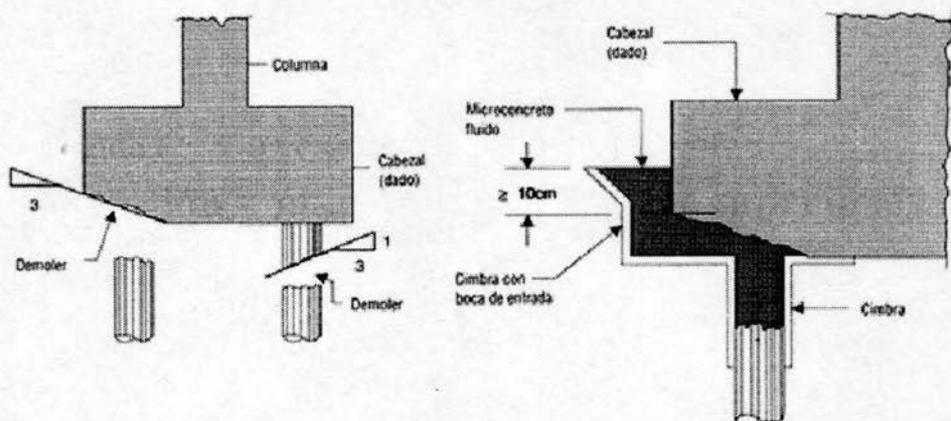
Cimentaciones. Refuerzos – Pilotes a) Microconcreto fluido y b) concreto
